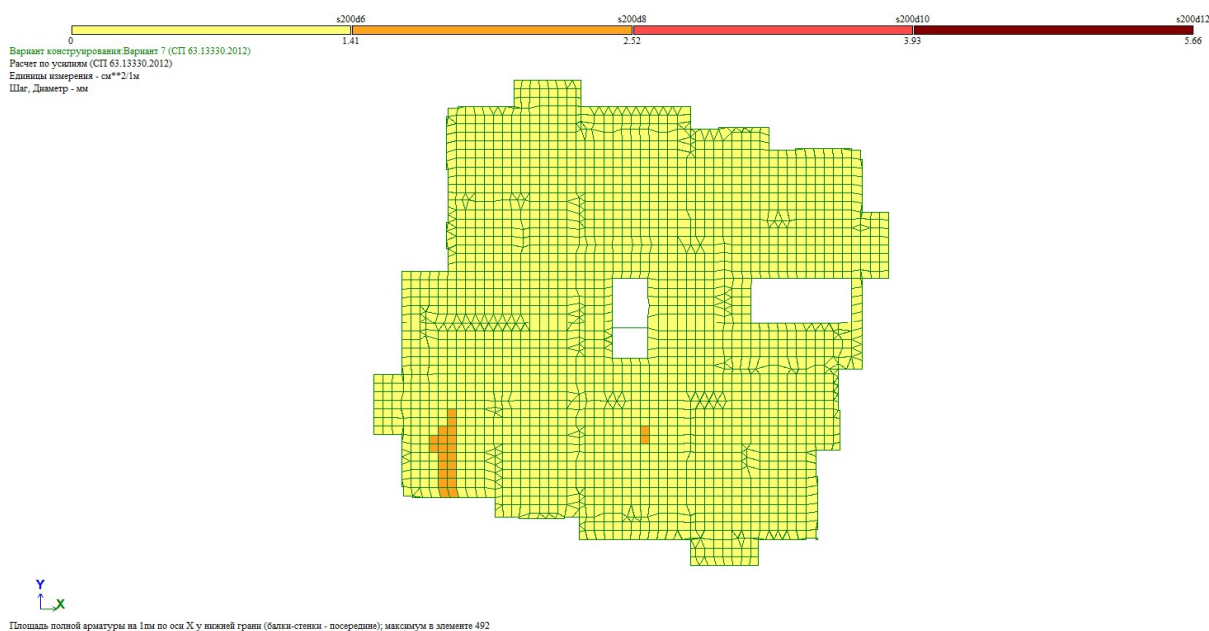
Нижнее армирование перекрытия этажа по оси X
